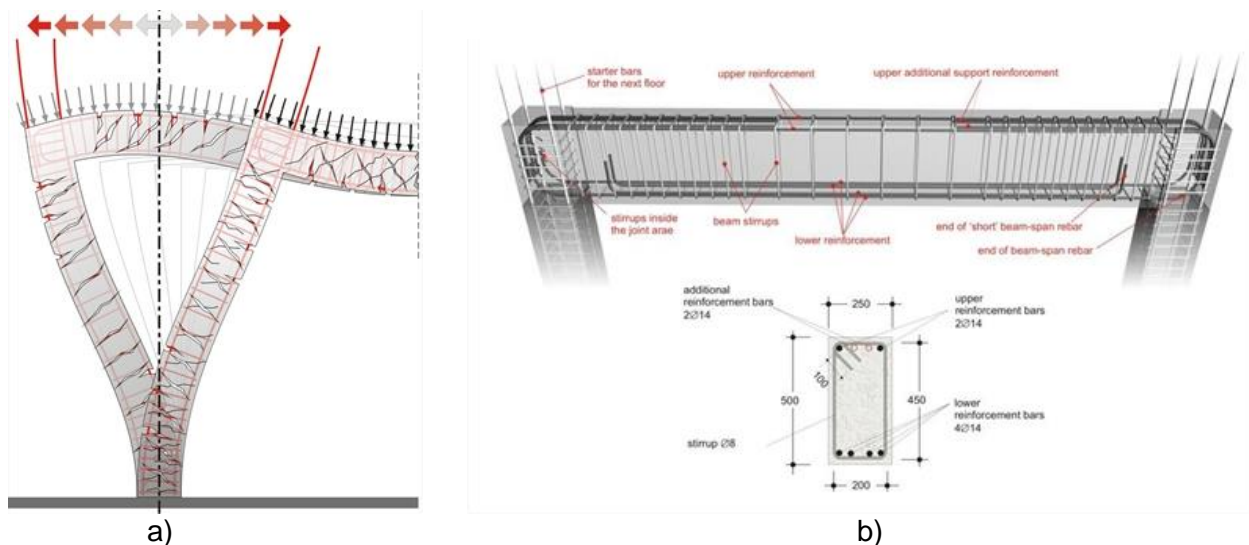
a) Pórtico simulando fuerzas sísmicas. b) Detalle de viga de pórtico
